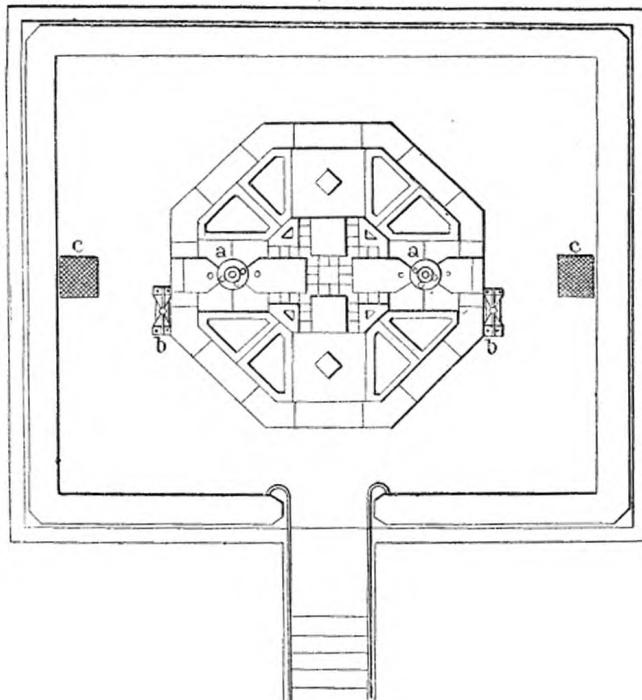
Plan de la plate-forme du pavillon des Siphons.
